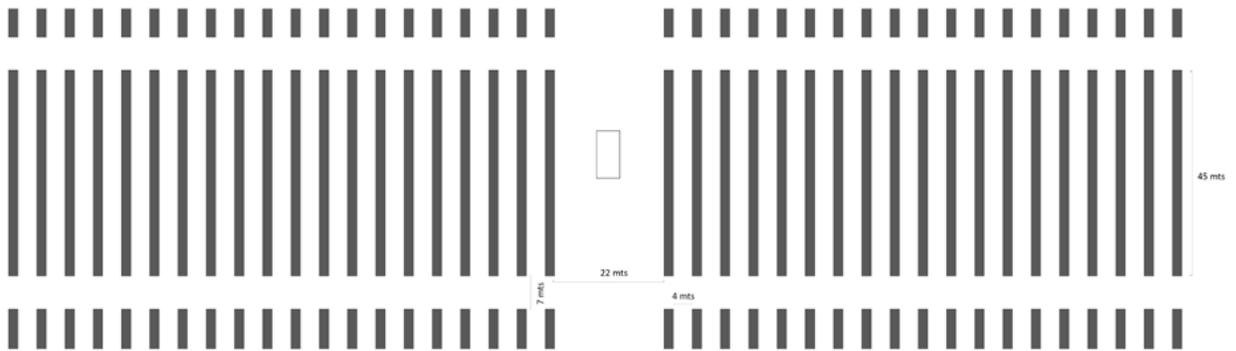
Zoom planta del parque solar fotovoltaico "Salvador PV"
